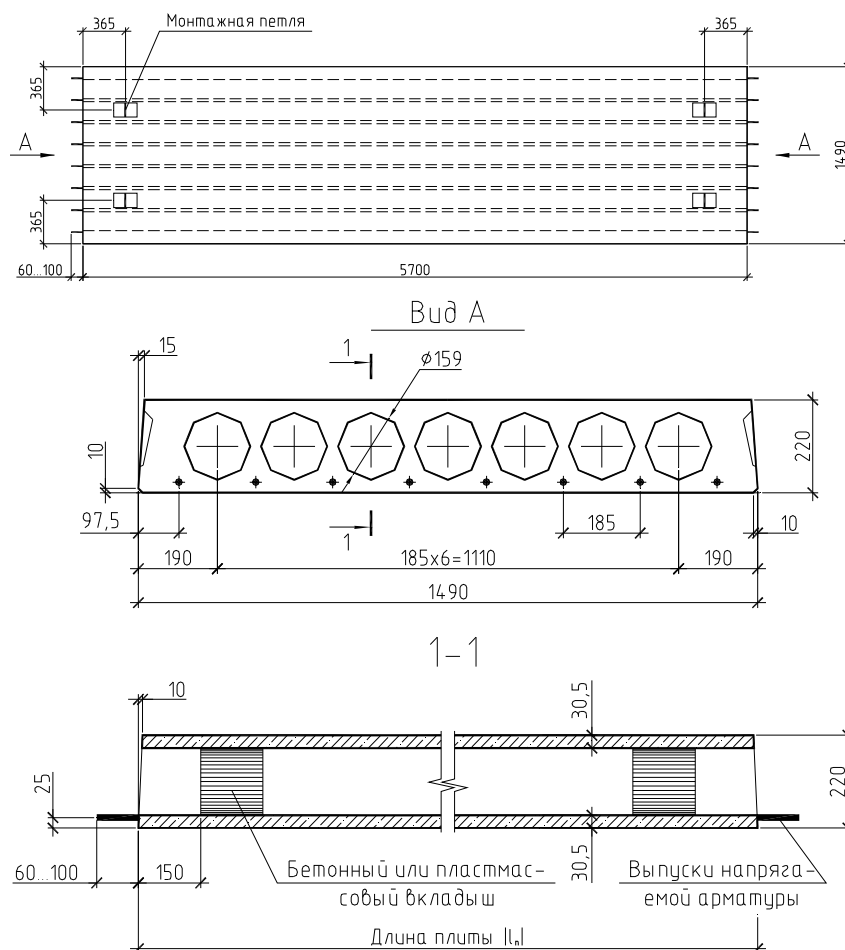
Многopустотная плита перекрытия (размеры условные)
